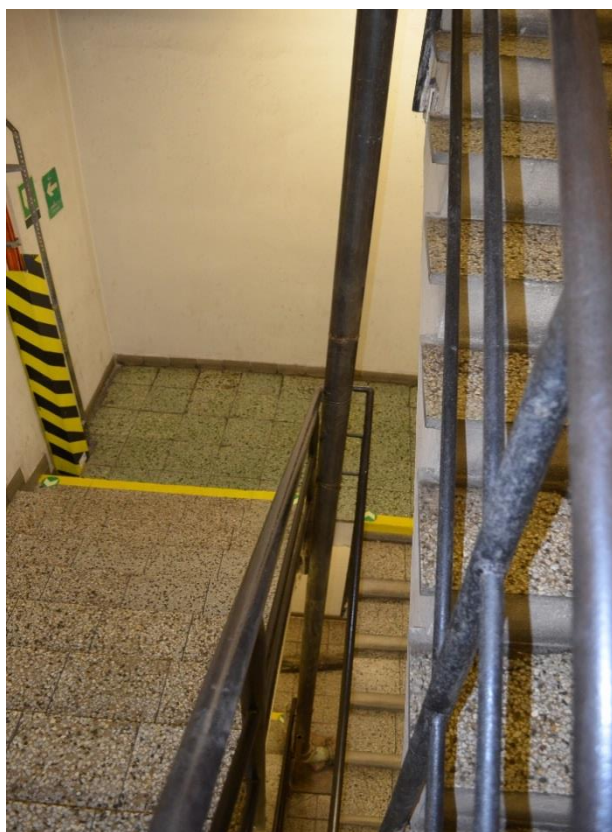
Začátek trasy potrubí od betonpumpy do stanice metra (archiv autora)
